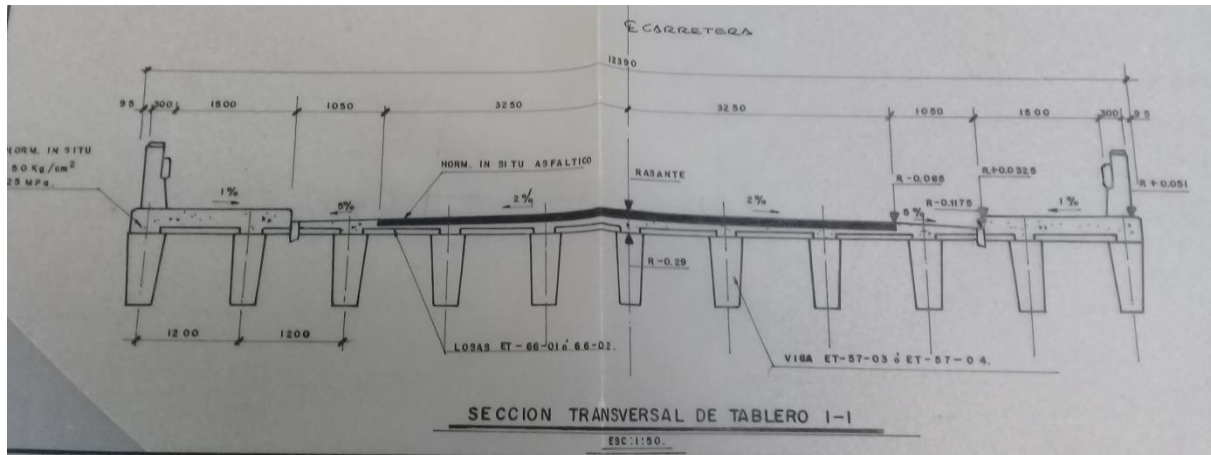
Sección transversal del tablero del Puente Nuevo Buey Vaca.(Hernandez and Dominguez 1990)
